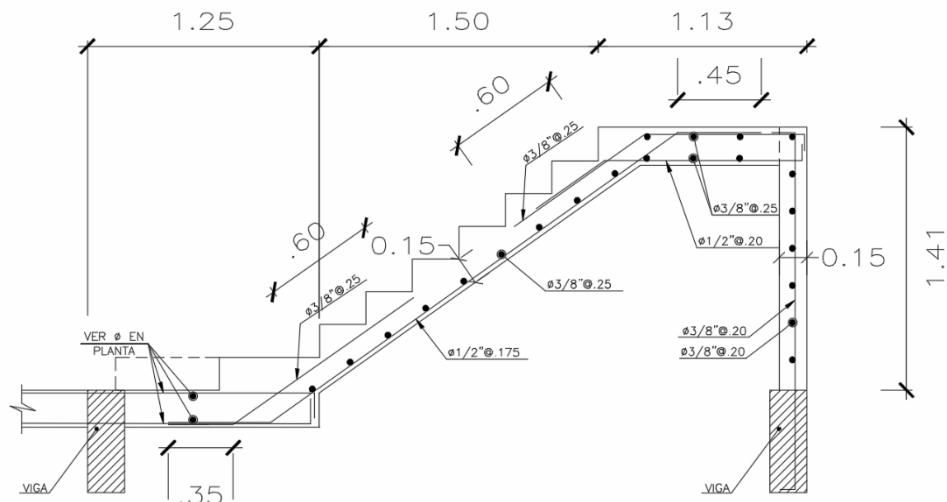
Detalle de armado del primer segmento de escalera de piso típico
